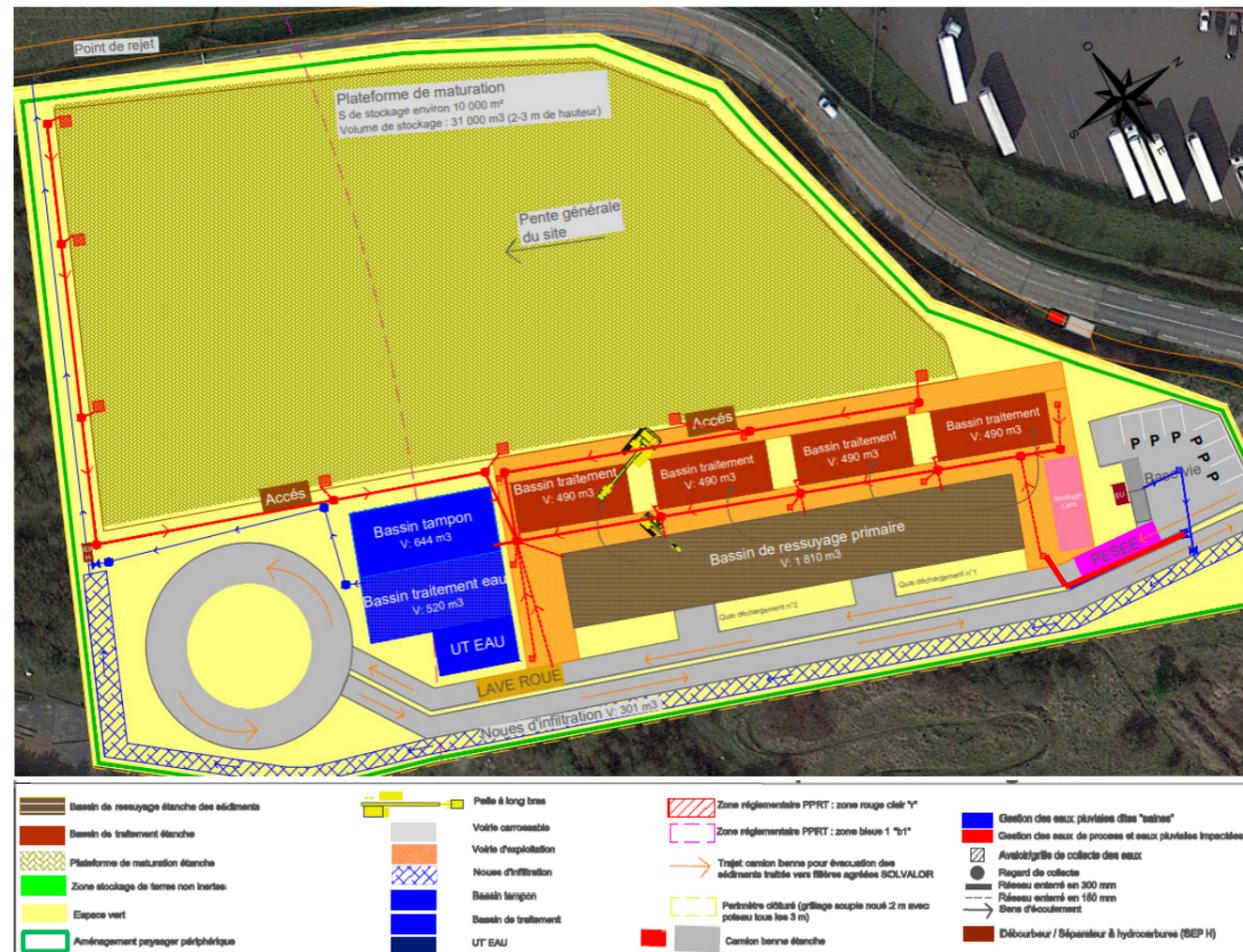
Plan de gestion des eaux pluviales sur le site ICPE
